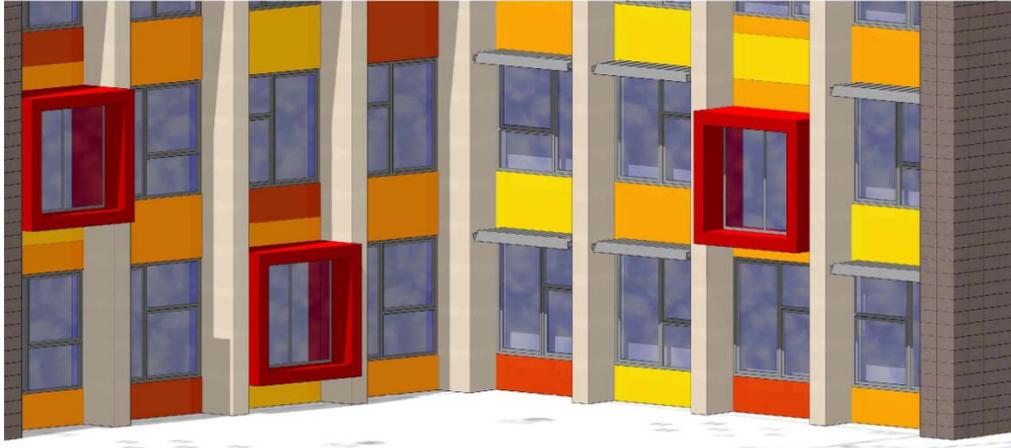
Kreuzbau: Fassadenansicht mit „Lese-/ Kuschelecken“
